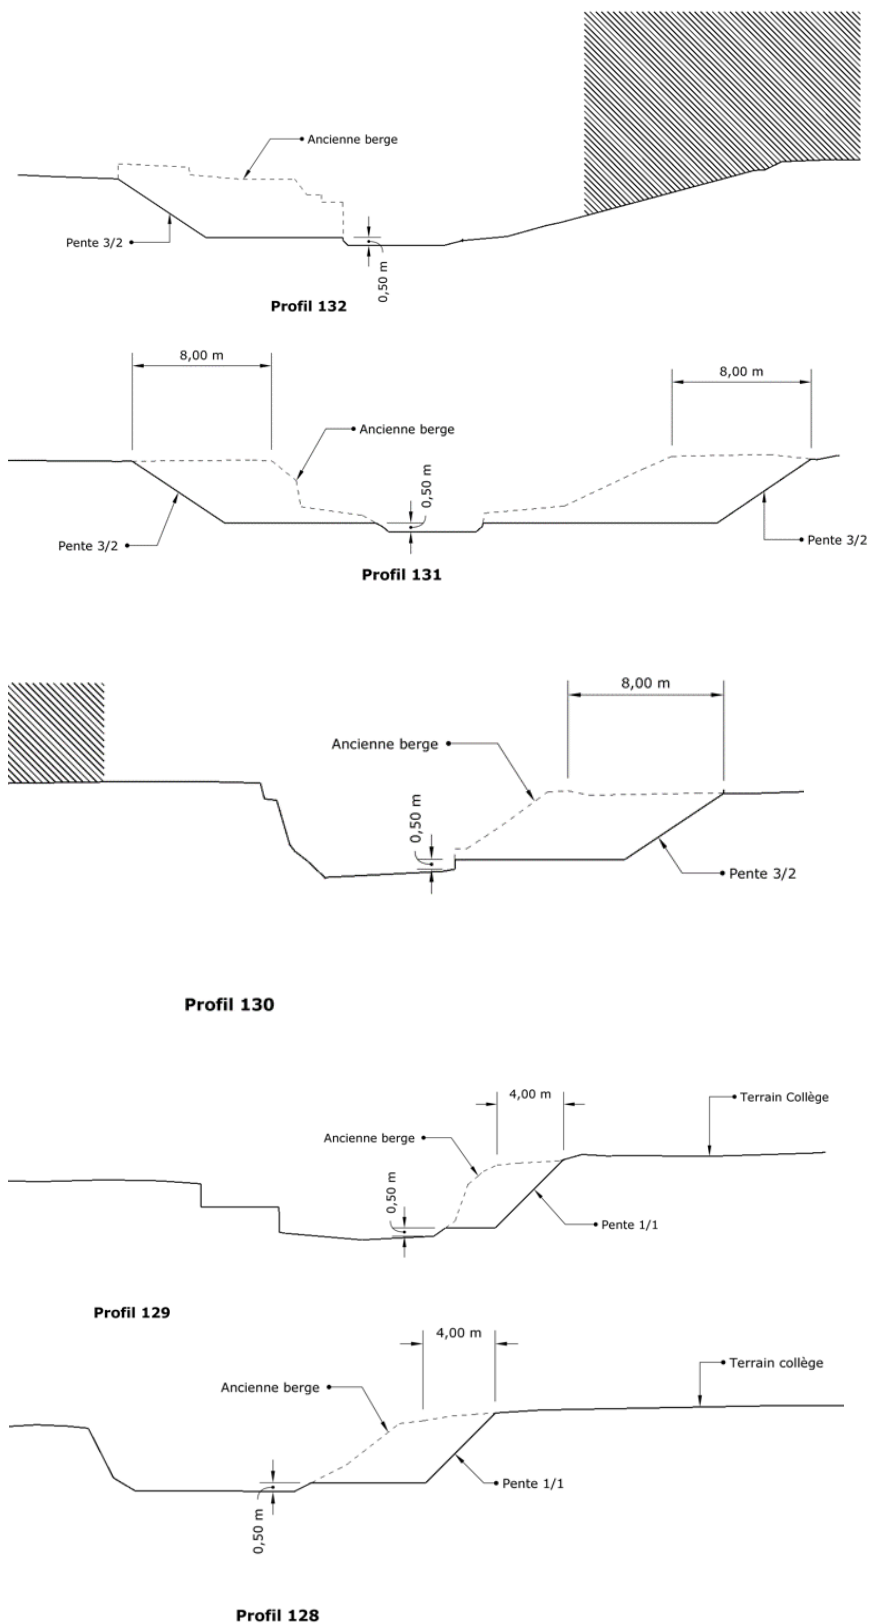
Coupe en travers et périmètre de la zone de reprofilage
